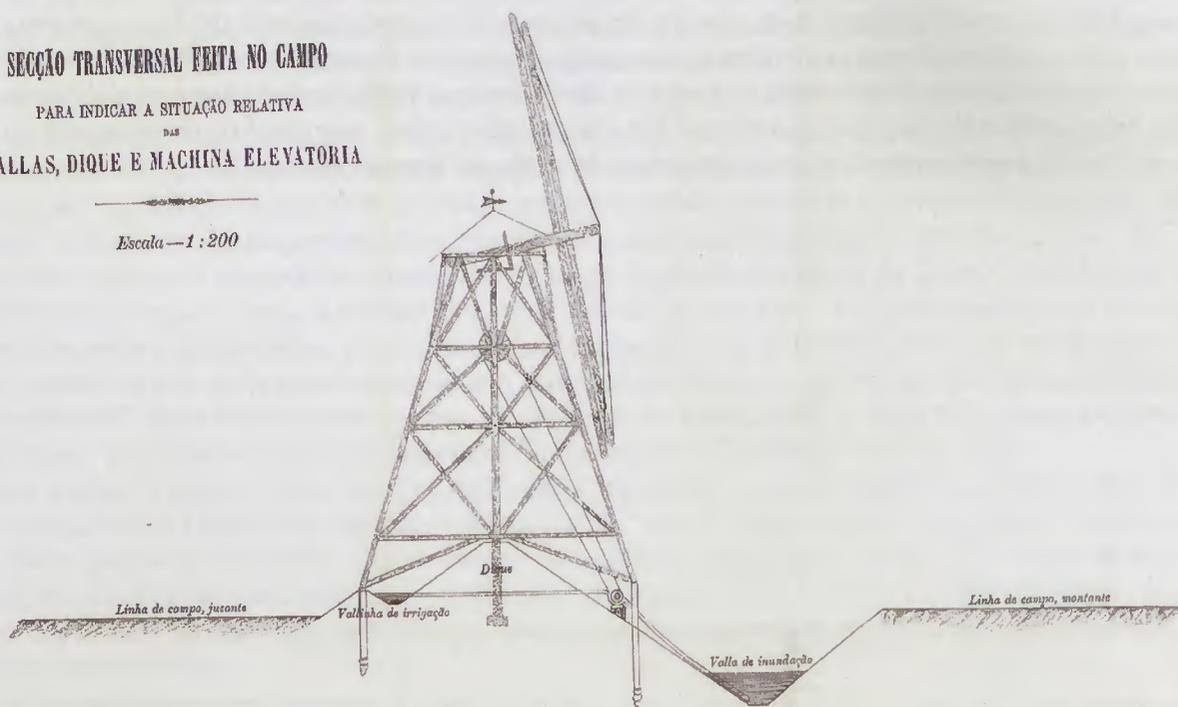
Máquina para elevação de água destinada à drenagem dos campos da Asseca, Santarém.
